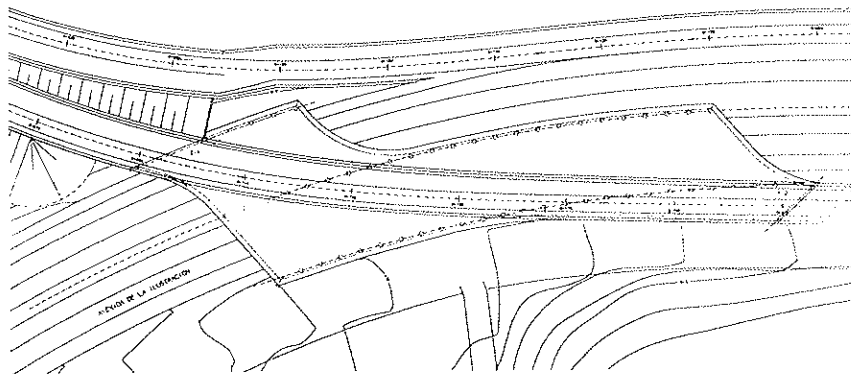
Estructura sobre la Avenida de la Ilustración. Planta.
